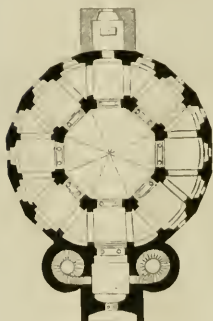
Grundriss der Palaftcapelle zu Aachen.
